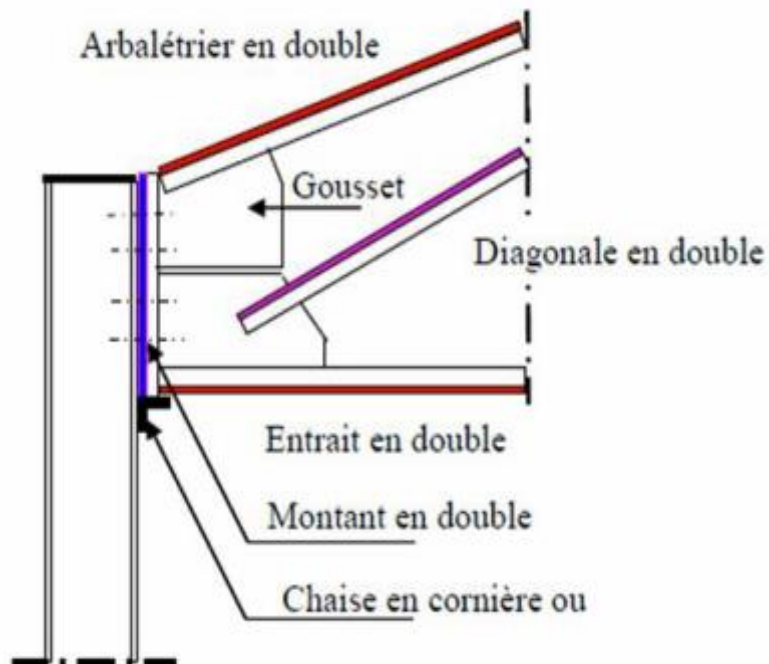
Assemblage au jarret d'une ferme sur un montant en profilé.
